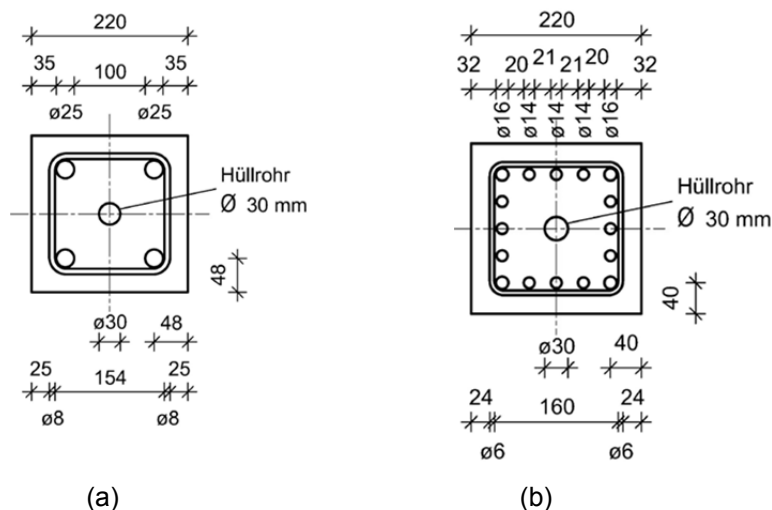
Querschnitte der Diagonalen mit Bewehrungsanordnung; (a) Diagonale - Bewehrung in den Ecken (b) Diagonale - Bewehrung umfangsverteilt (Maße in mm) (Biadatz 2017)
